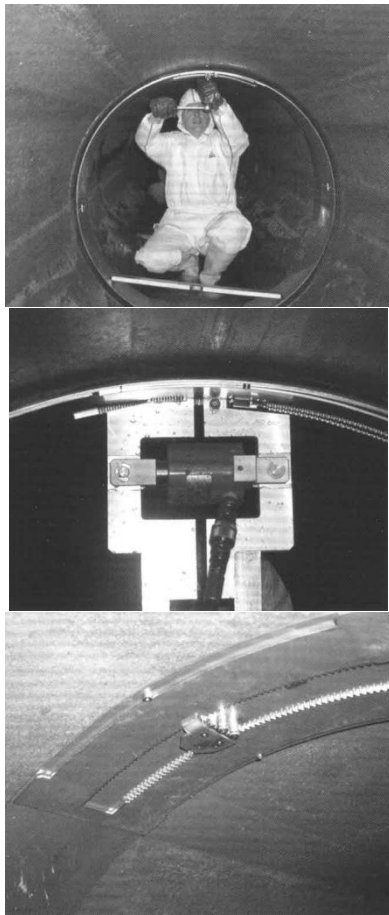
Система быстрого крепления элементов облицовки в ремонтируемом трубопроводе, разработанная немецкой фирмой Uhrig Straßen-Tiefbau GmbH
